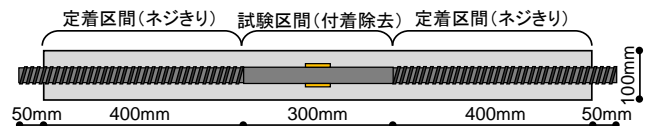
鉄筋拘束ひび割れ試験体概要
